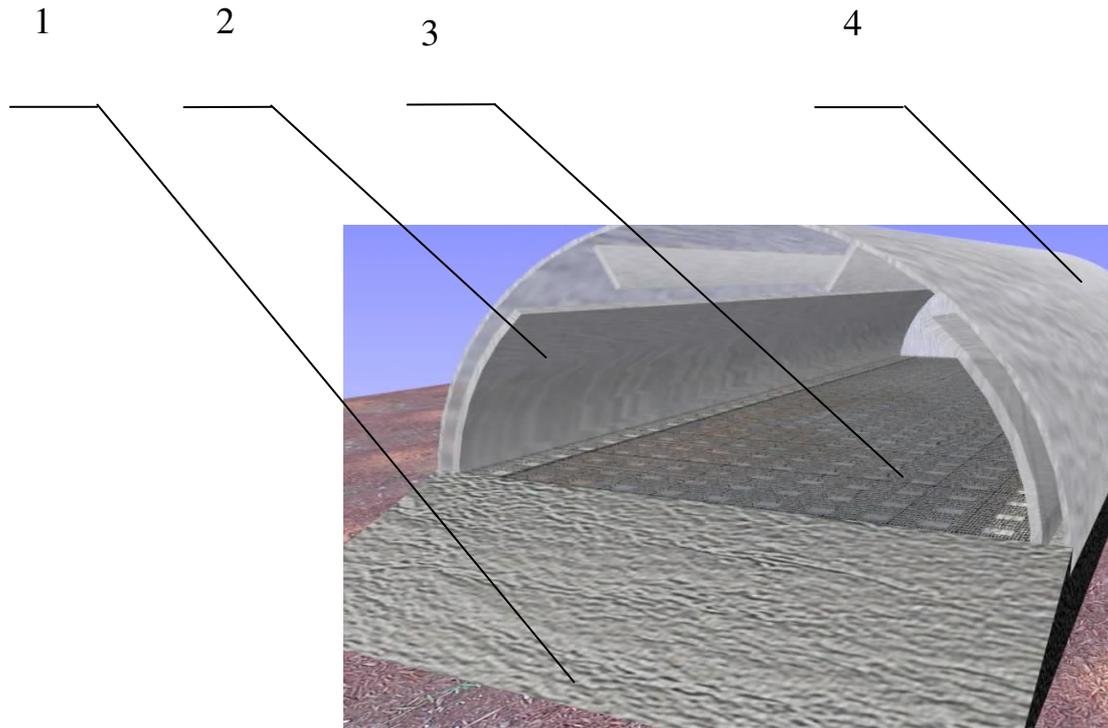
Моделирование у 3D зернохранилище: 1 – фундамент; 2 – перегородки; 3 – решетки; 4 – крыша.
